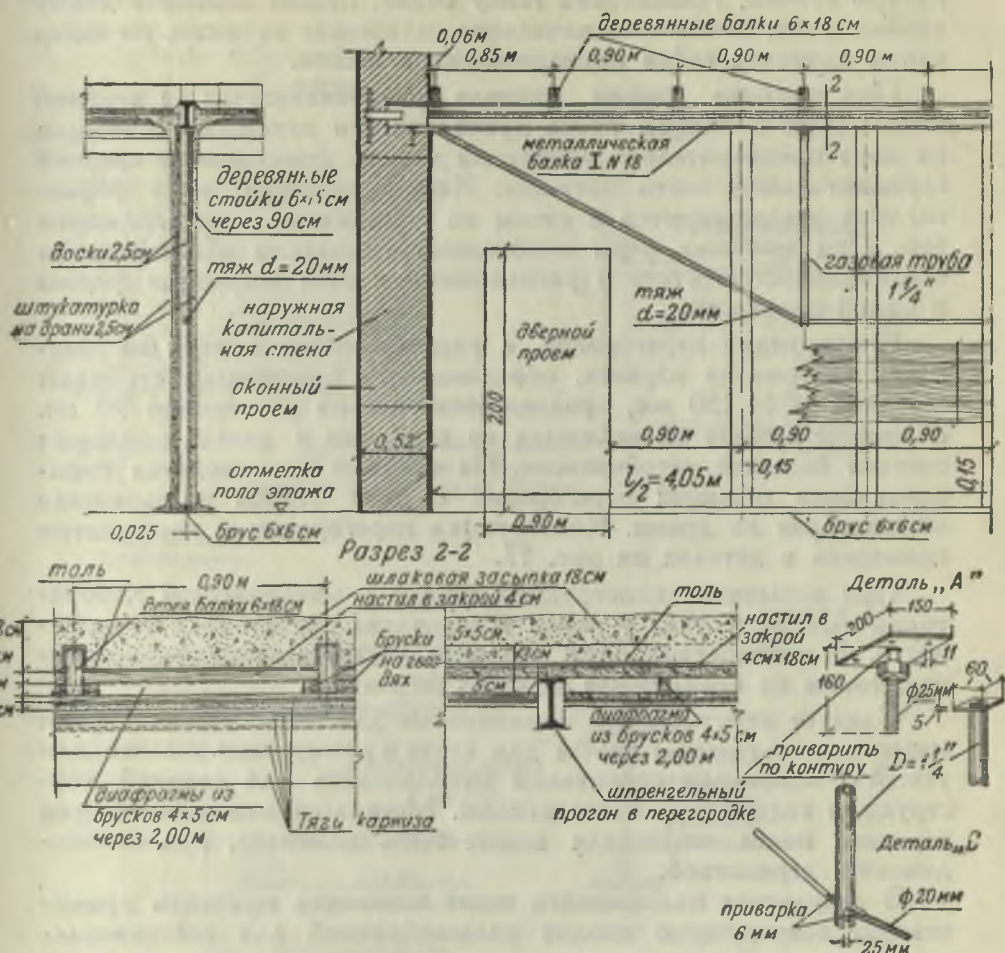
Конструкция шпренгельной балки при восстановлении перекрытий д. № 7 по Фивскому пер.
